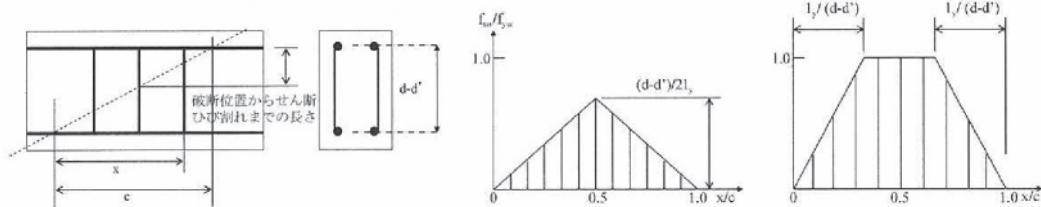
斜めひび割れ内の破断したせん断補強鉄筋応力
